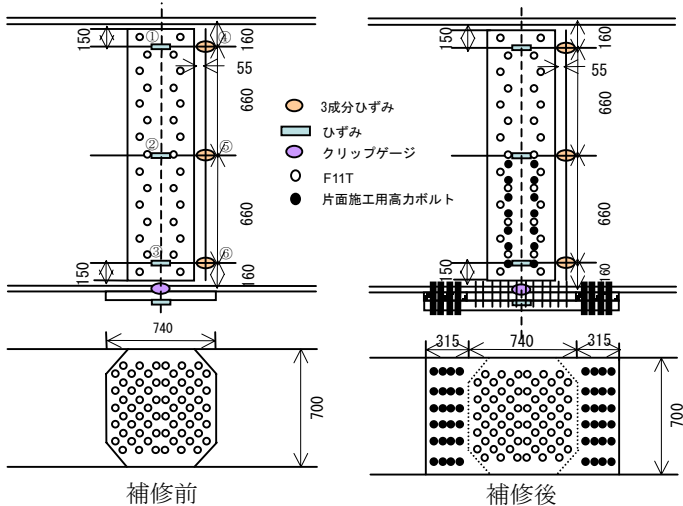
片面施工用ボルトの配置及びひずみゲージ貼付位置
